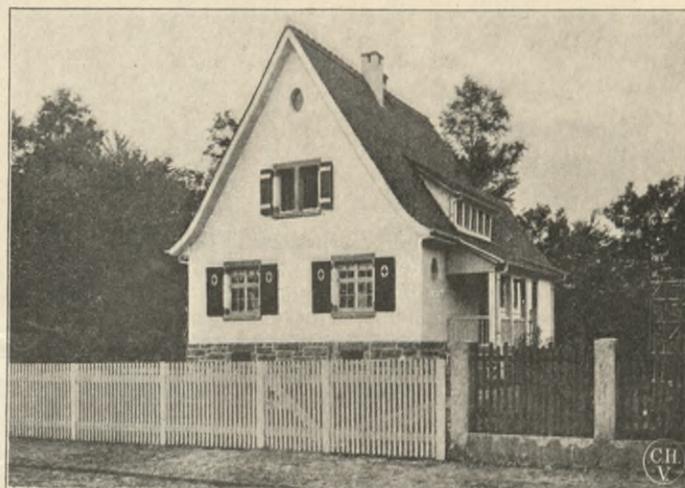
Landhaus Krebs in Buchschlag. Architekt Grüning
